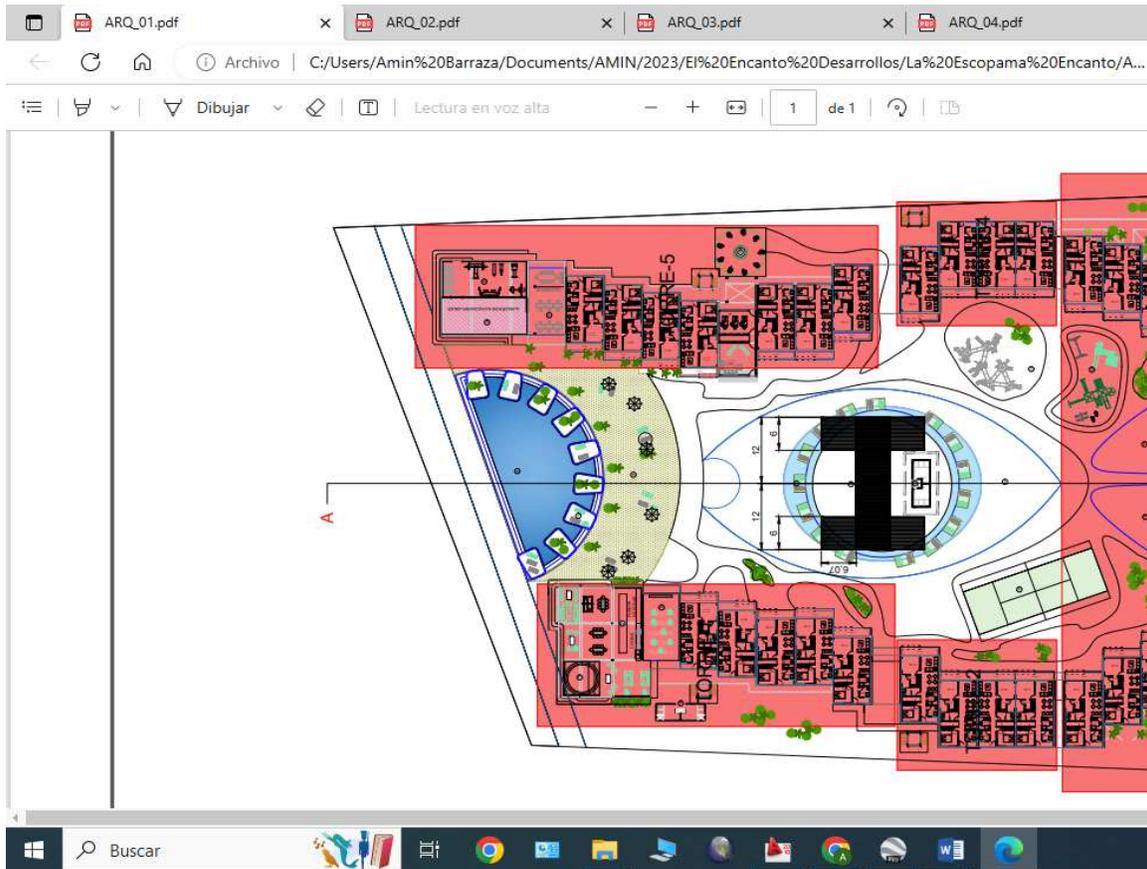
Planta subterráneo, estacionamiento, servicios y su acceso. Ver Anexo 4. Plano Arq-01.
